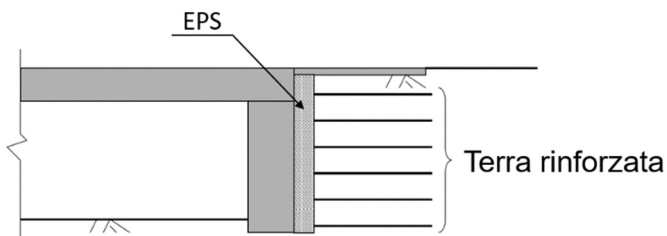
Soluzione progettuale finalizzata ad evitare la fessurazione della pavimentazione stradale al contatto tra rilevato e viadotto (modificato da Horvath 2005).
